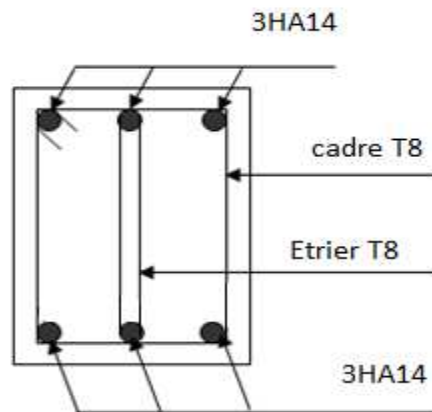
Schéma de ferrailage de la poutre de palière.
